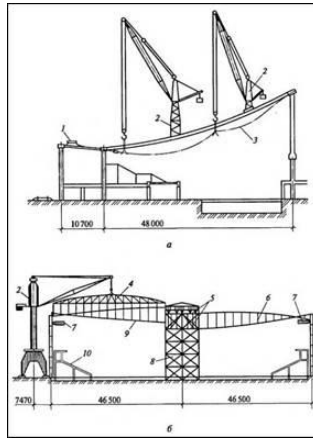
Технологические схемы перекрытия больших пролетов висячими конструкциями
